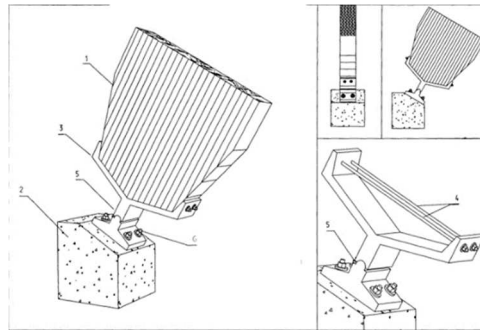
Схема опорного вузла рами з шарніром хитаючого типу.
